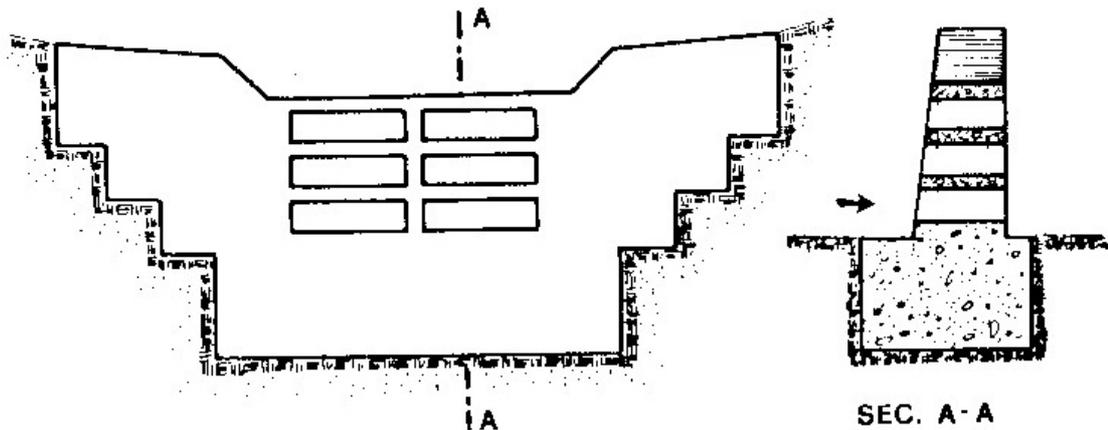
Dique con alcantarillas o ventanas múltiples (fuente: AIDI-IILA, 1983).
